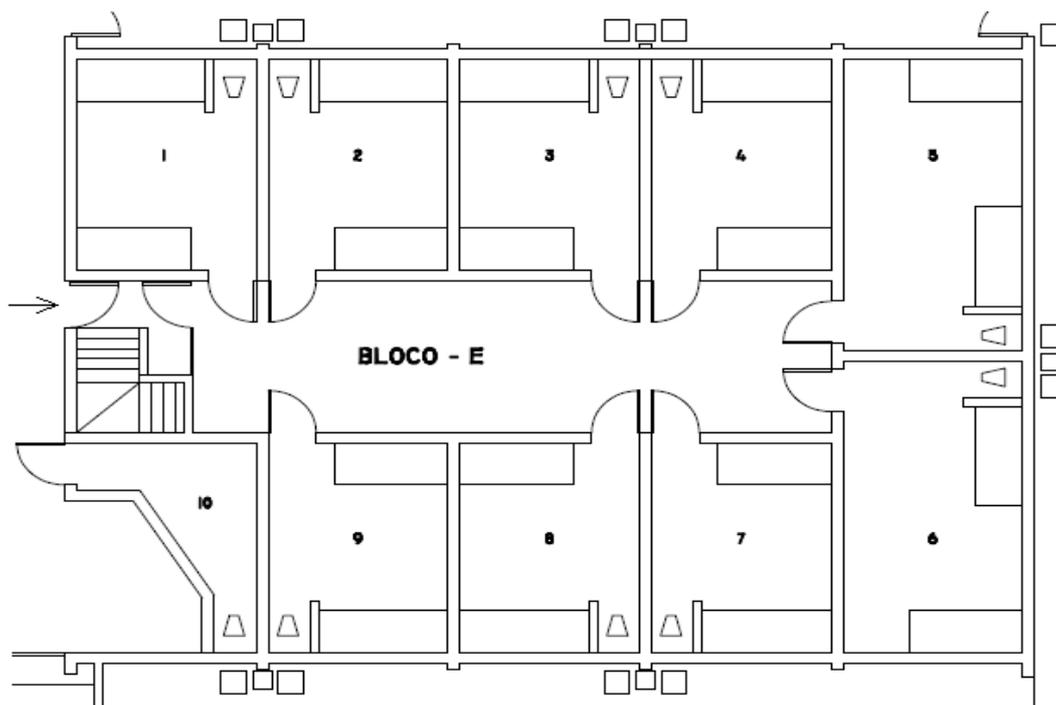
Planta Baixa da Casa de Detenção de Pedrinhas – BLOCO E.
